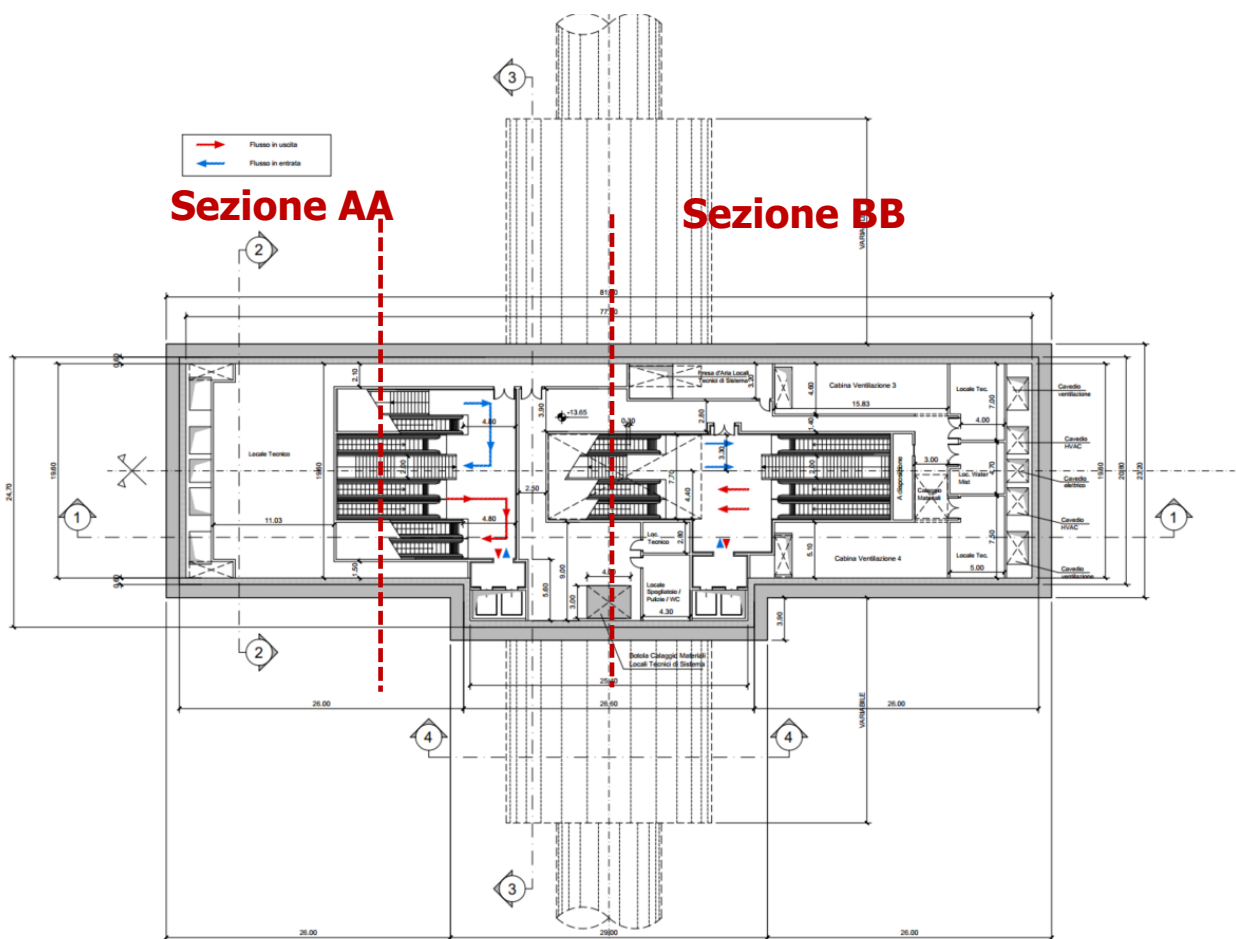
Stralcio planimetria stazione Mole/Giardini Reali con indicazione della sezione di calcolo AA e BB
